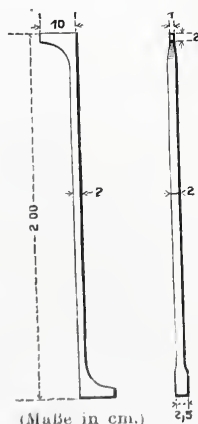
Eiserner Stampf zum Dichten des Betons in dünnen Lagen.
